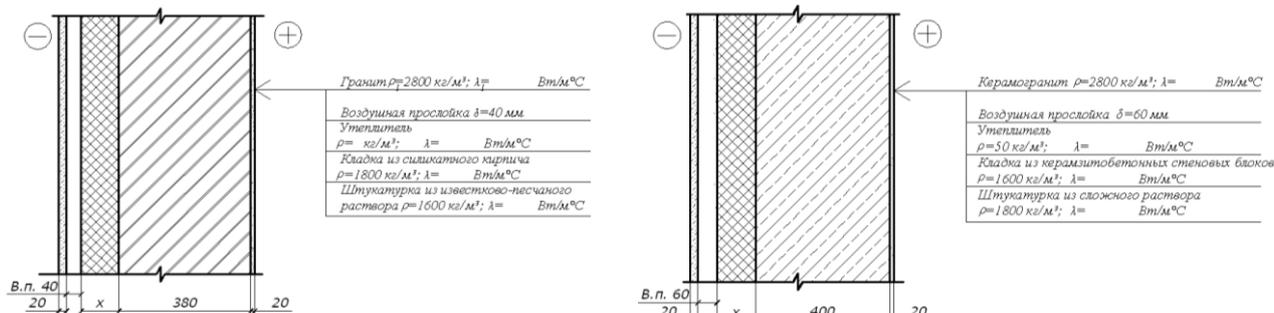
Примеры выполнения конструкции стенового ограждения для стен из силикатного кирпича и из керамзитобетонных стеновых блоков
